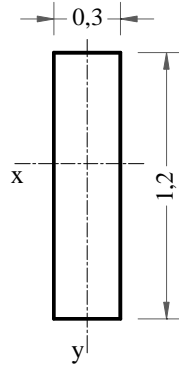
Sección de la Viga V2. Las Medidas están dadas en Metros
